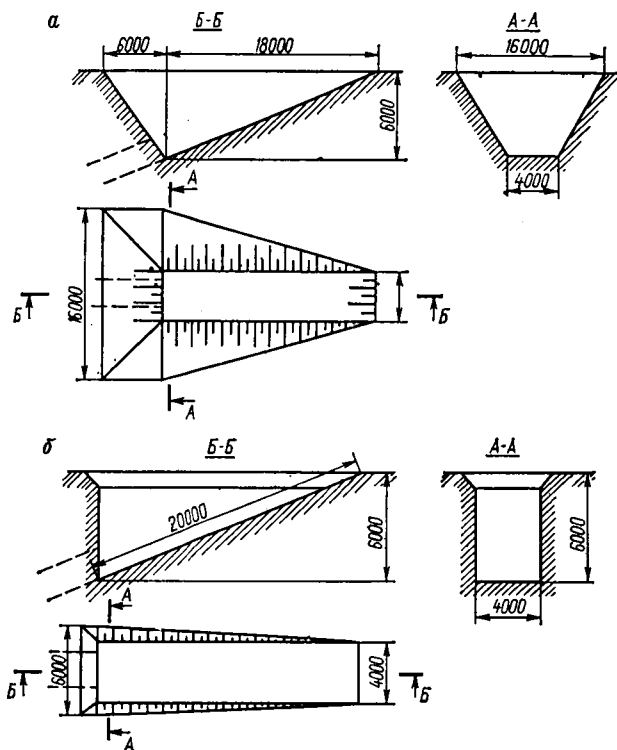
Схемы проведения устьев наклонных стволов в породах:
